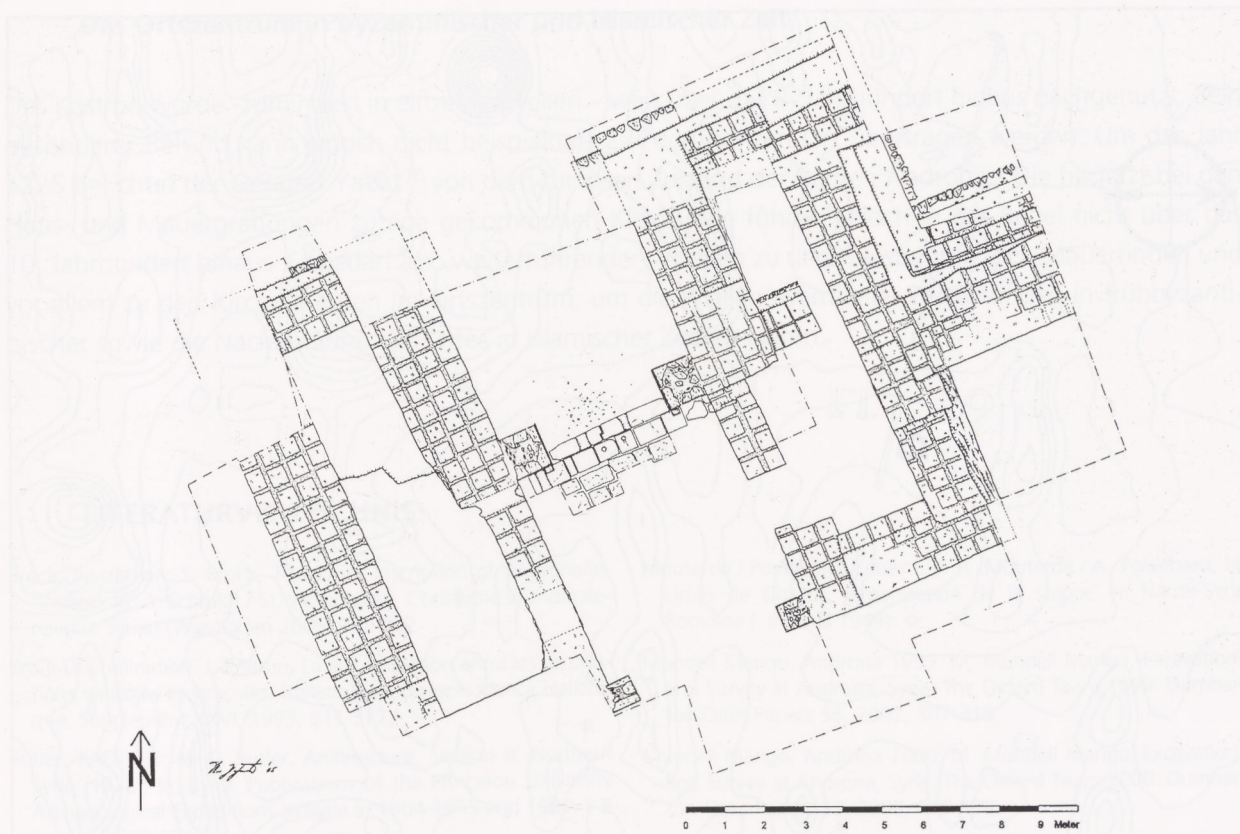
Androna. Äußerer Mauerring, Grundriss der nordwestlichen Toranlage.
